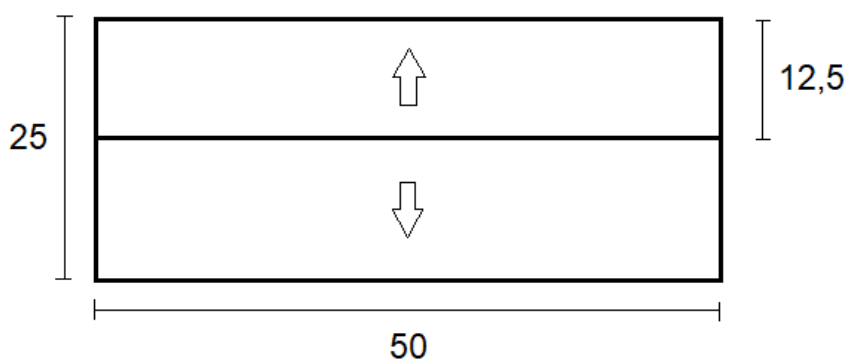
Planta cubierta del edificio situado en Gandía.
